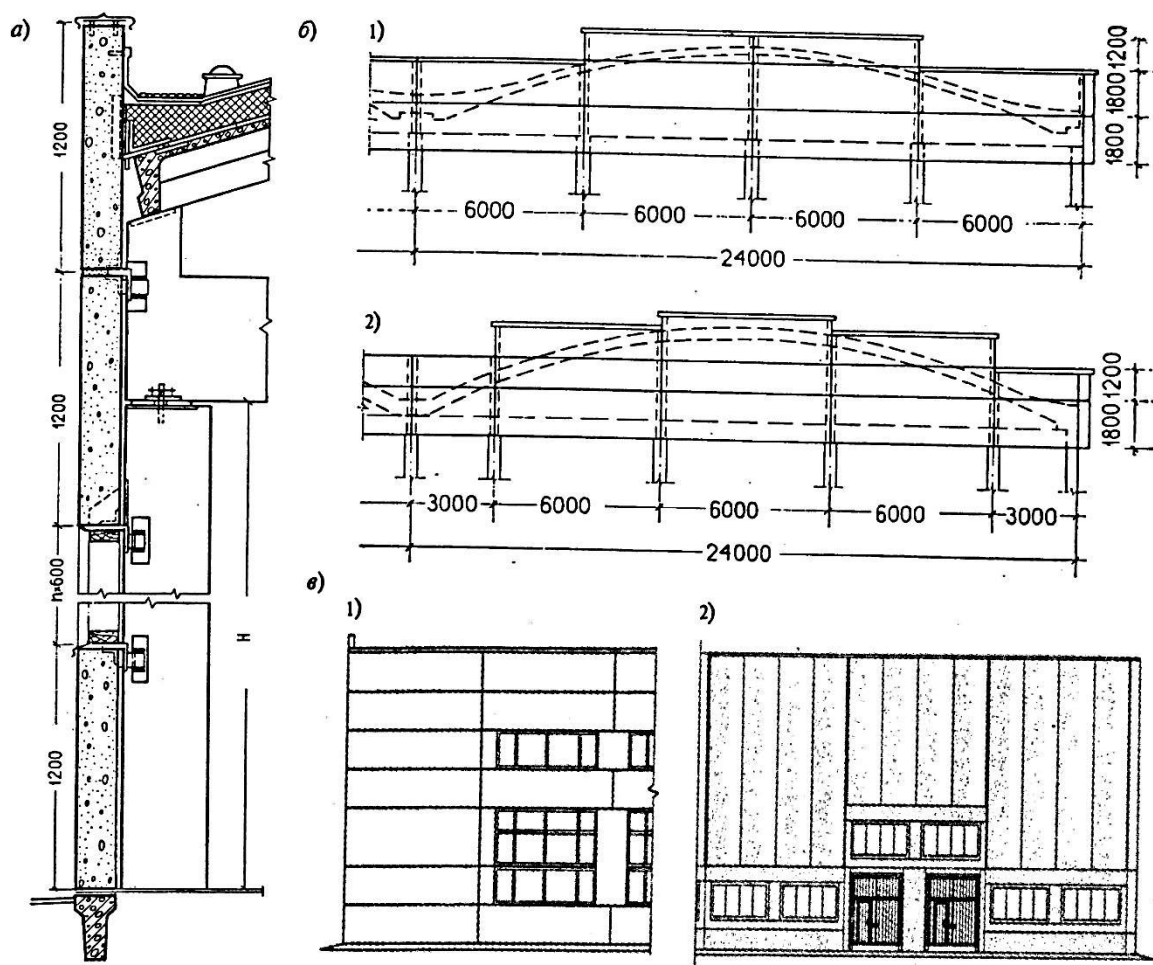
Варианты разрезки стеновых панелей одноэтажных промышленных зданий: *а* - разрез стены из крупных панелей; *б* - в торцевых стенах при покрытиях по сегментным фермам: 1 - длиной 6 м; 2 - длиной 3 и 6 м; *в* - варианты разрезки стен на панели в продольных стенах: 1 – горизонтальная; 2 – вертикальная разрезка в сочетании с горизонтальной
